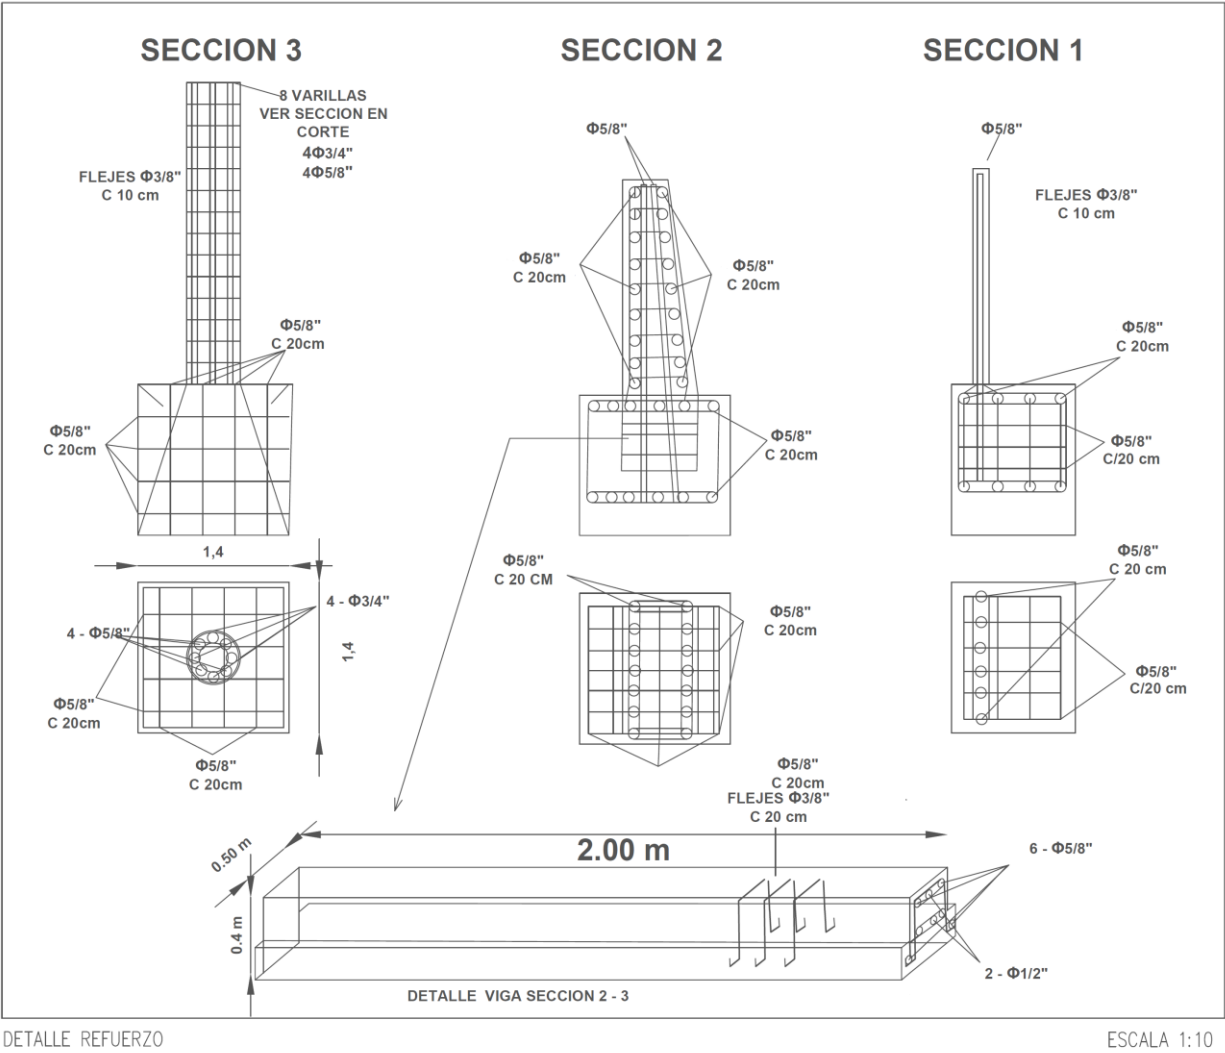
Detalle de los refuerzos. Fuente: Plano Muro San Blas
